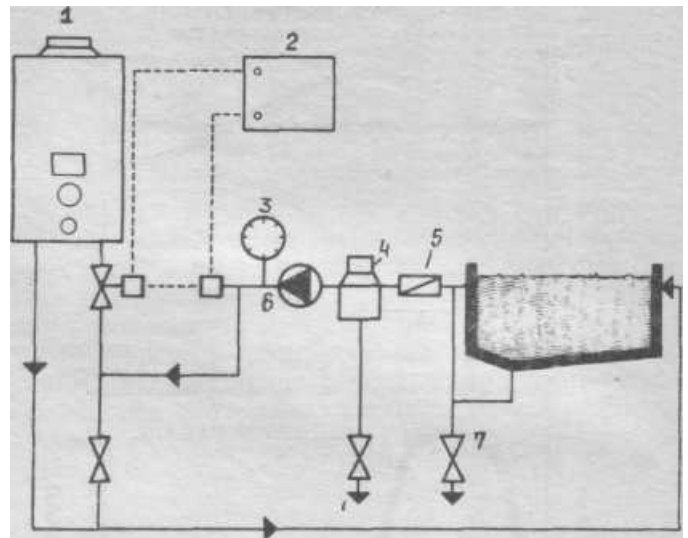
Прямоточный газовый нагреватель для обогрева открытого бассейна
